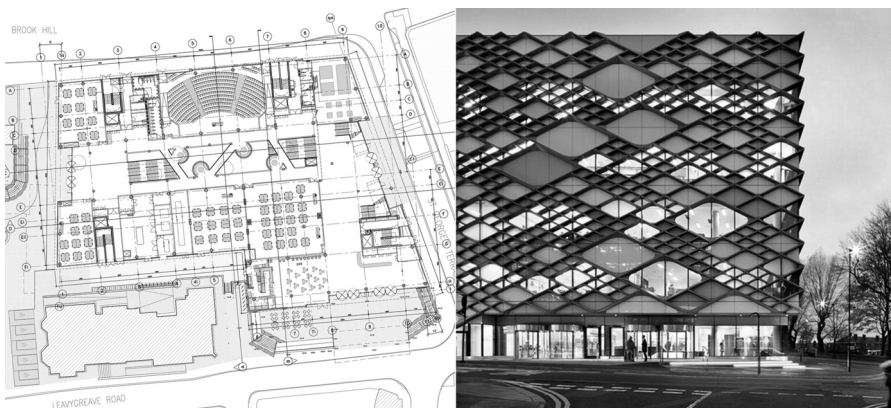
Plan przyziemia. Elewacja frontowa.
